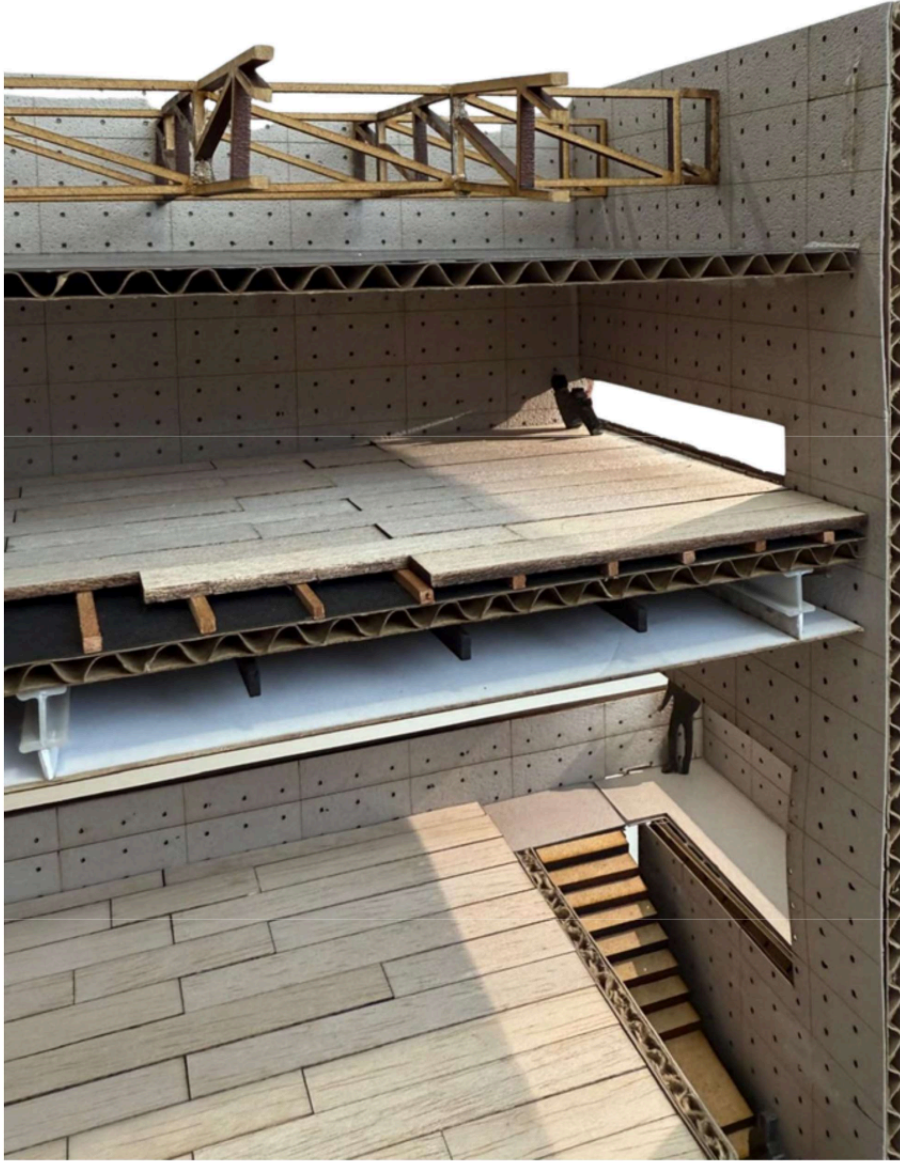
Técnica del proceso constructivo. Fuente: *Elaboración propia 2025
